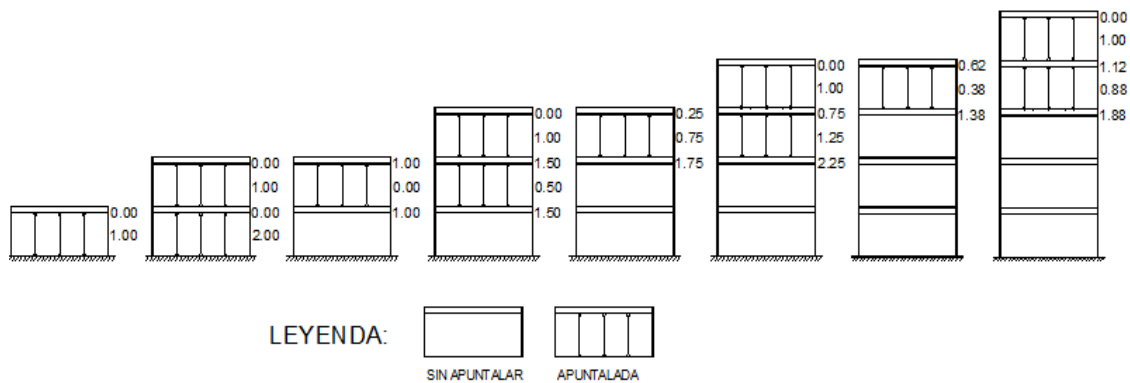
Distribución de cargas para el ciclo de dos plantas apuntaladas según el Método Simplificado. [Grundy y Kabaila (1963)]
